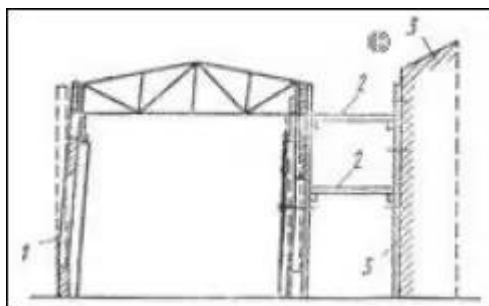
Крепление наклонившейся стены к стенам устойчивых зданий:
